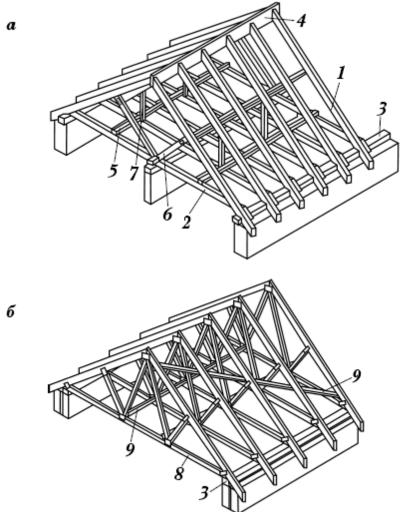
Конструкция скатной крыши: а – со стропильными балками; б – со стропильными фермами: 1) стропило; 2) затяжка; 3) мауэрлат; 4) коньковый прогон; 5) дополнительный прогон под стойками и подкосами; 6) подкос; 7) стойка; 8) стропильная ферма; 9) дополнительные связи
